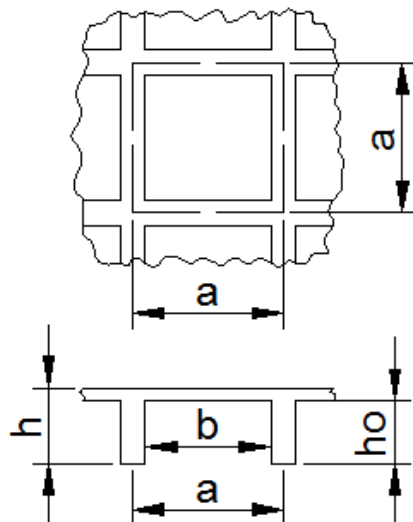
Dimensões utilizadas na determinação do peso próprio da laje nervurada.
